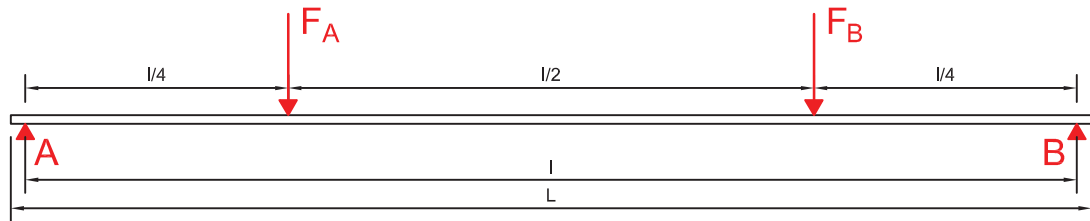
Versuchsaufbau mit Abmessungen, Lagerung und Lasteinleitung
